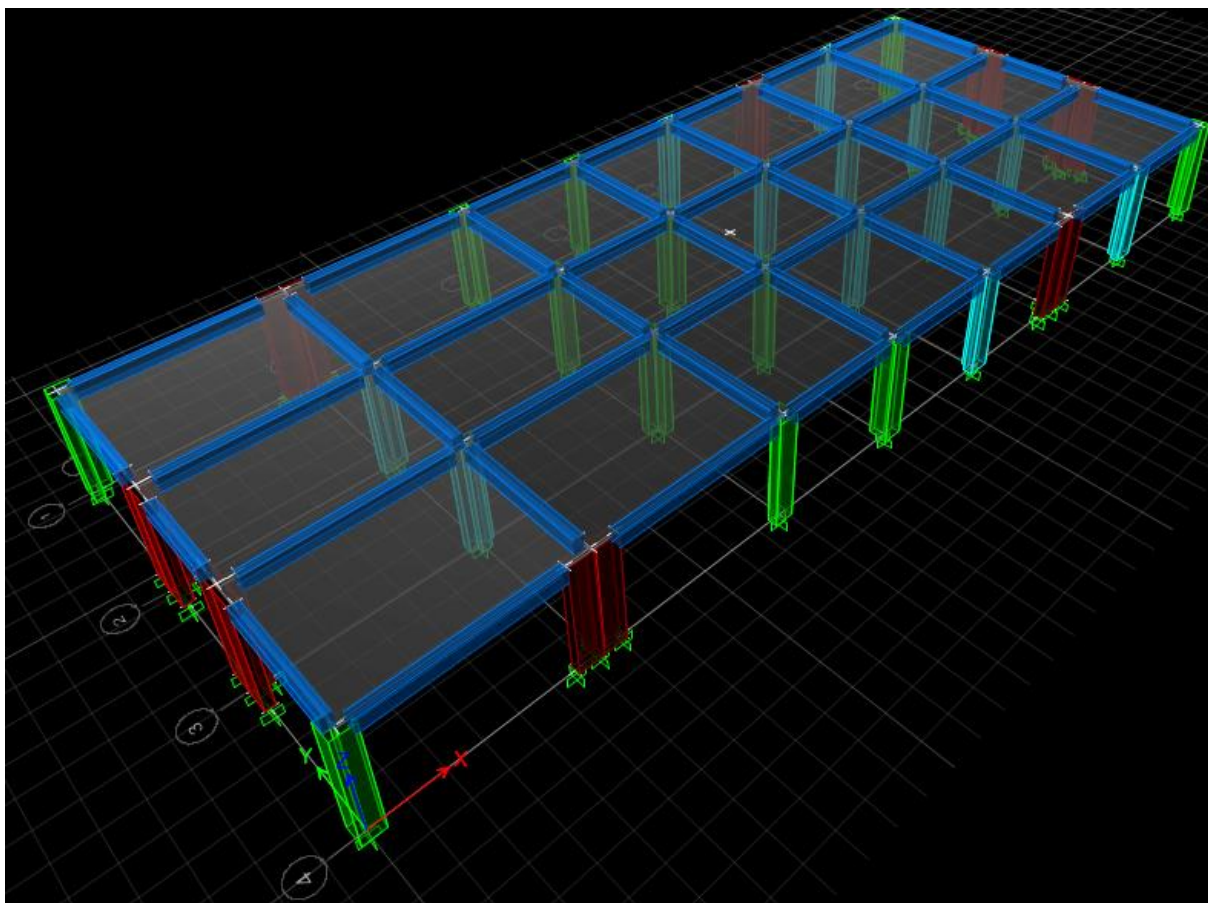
Vista 3D modelo estructural (Módulo 03)
